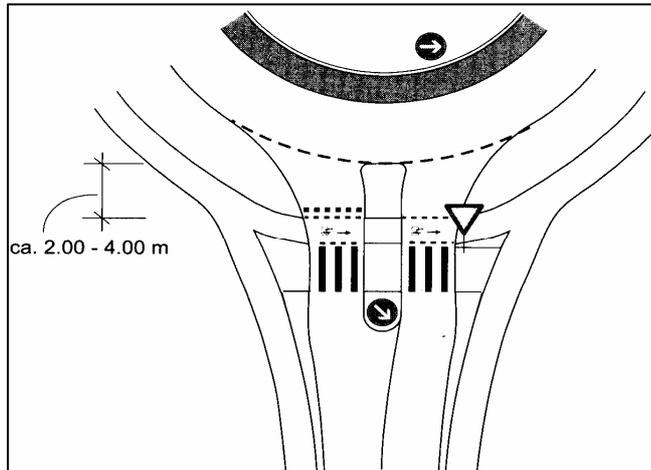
Parámetros para el diseño de glorietas urbanas
